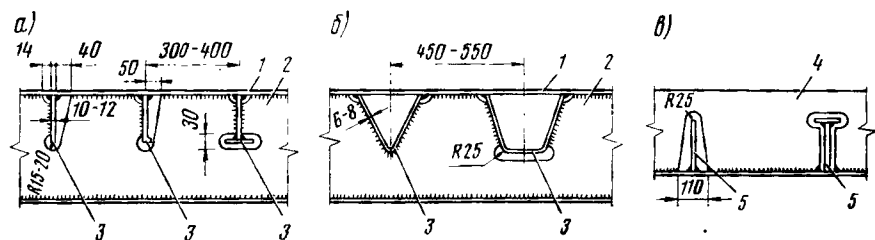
Типы сопряжений продольных ребер ортотропных плит с поперечными балками и ребрами:
